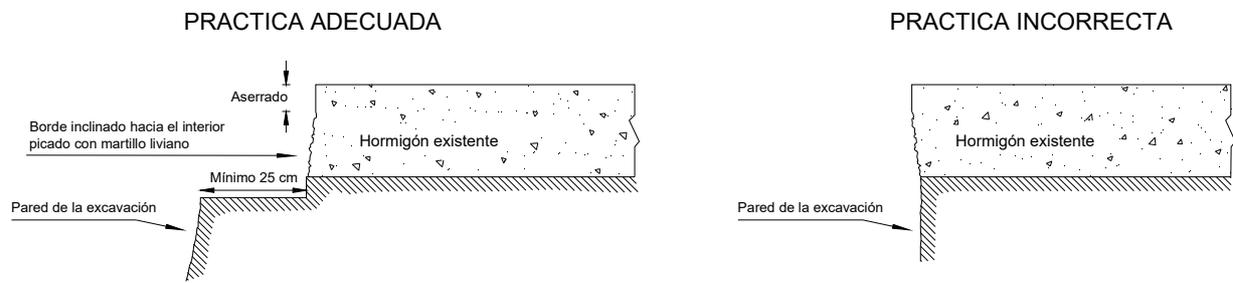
Sección transversal del corte de un pavimento y excavación. Prácticas adecuadas e incorrectas de bacheos en profundidad total o reparación (o nuevo tendido) de servicios públicos, en pavimentos para tránsito liviano.
